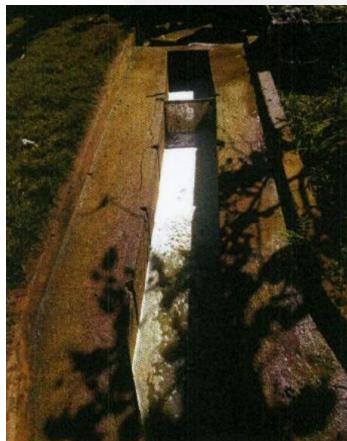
Parte da ETE industrial, local de lançamento do efluente
